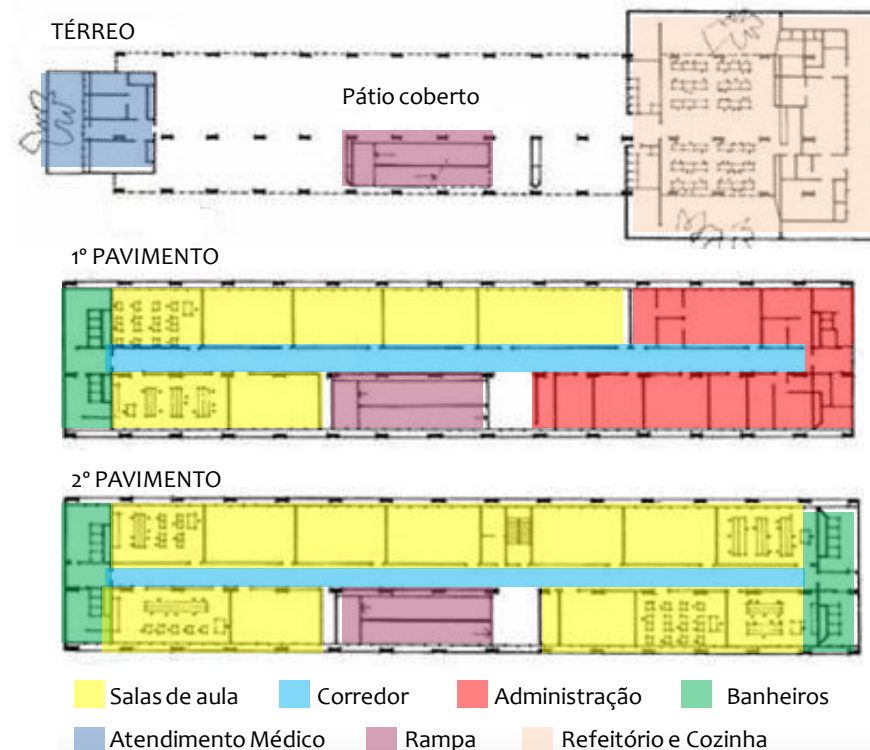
Plantas baixas – CIEP Tancredo Neves – Rio de Janeiro – 1985. Projeto de Oscar Niemeyer.
